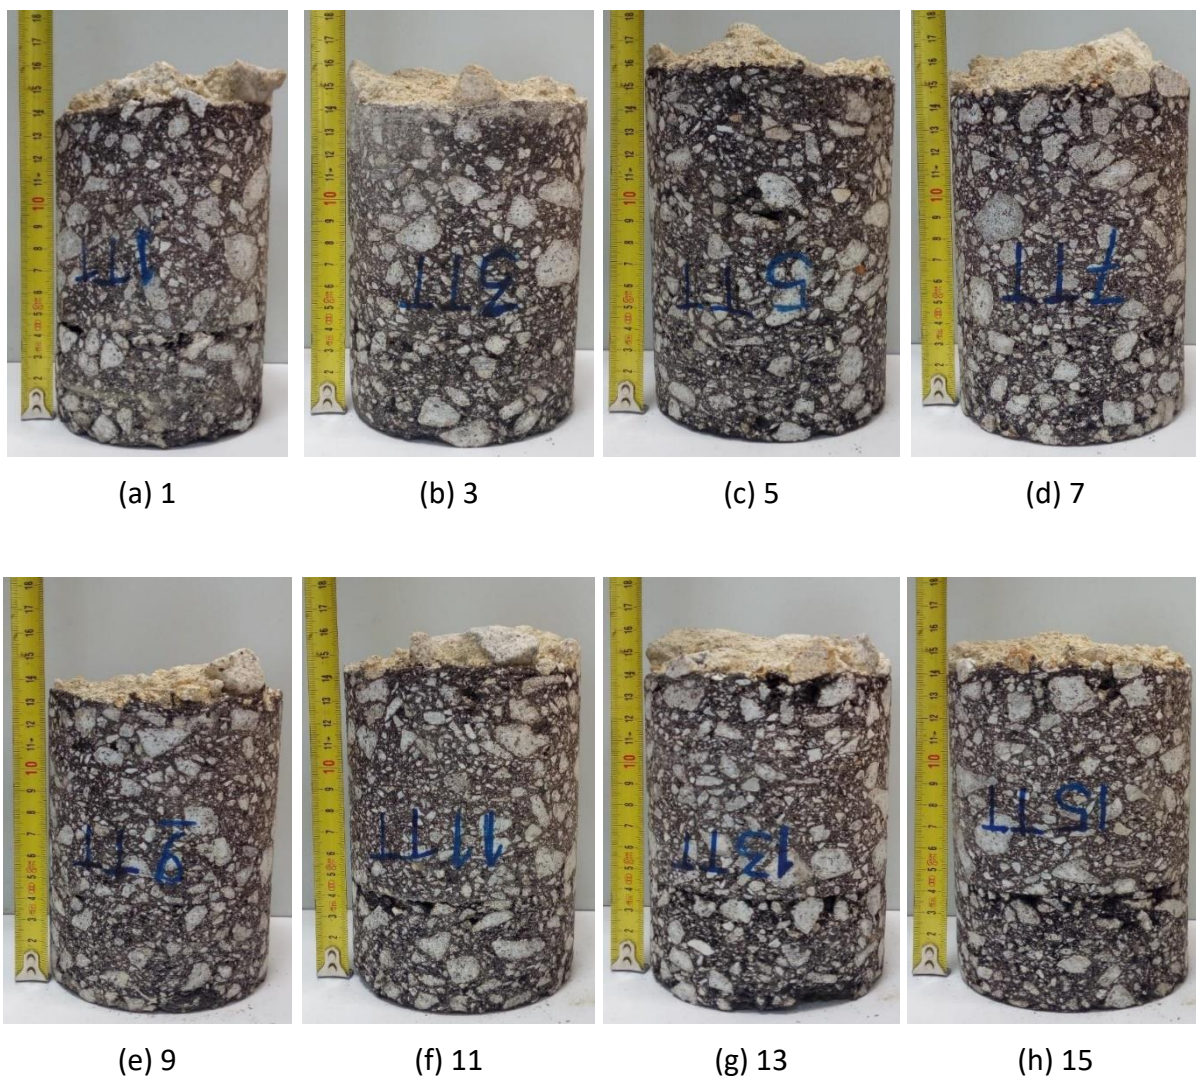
Conjunto de carotes extraídos da zona 1 do pavimento em estudo
